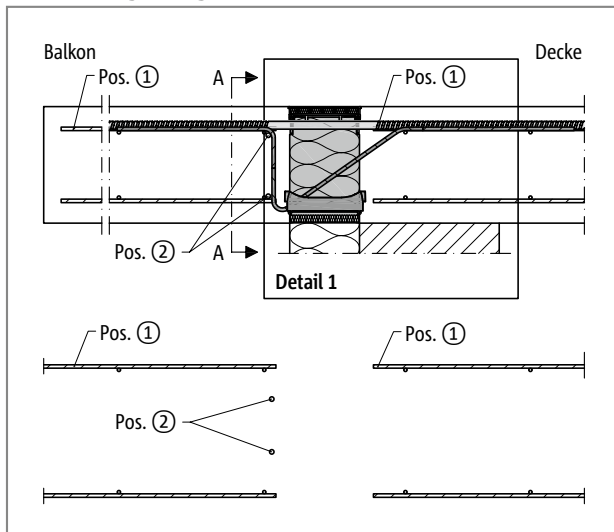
Schöck Isokorb® CXT Typ K: Bauseitige Bewehrung bei direkter Lagerung
